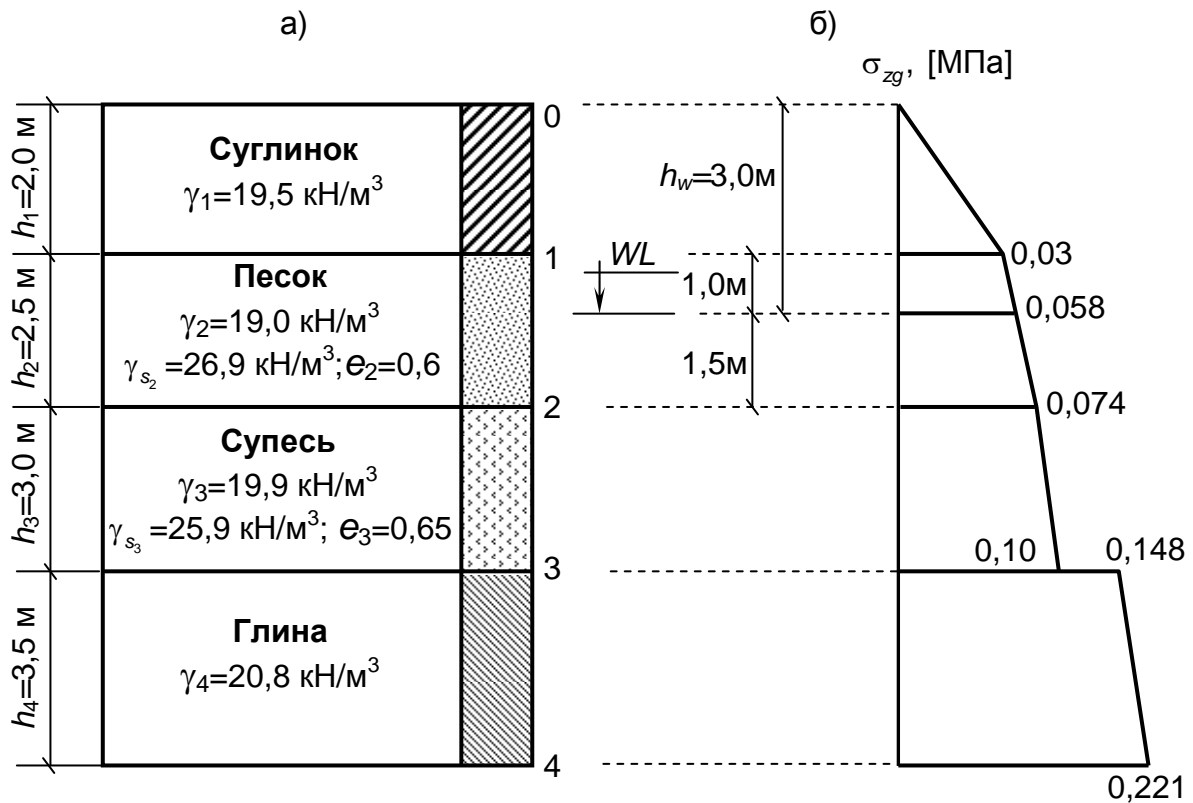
Грунты основания (а) и эпюра вертикальных напряжений от собственного веса грунта (б)
